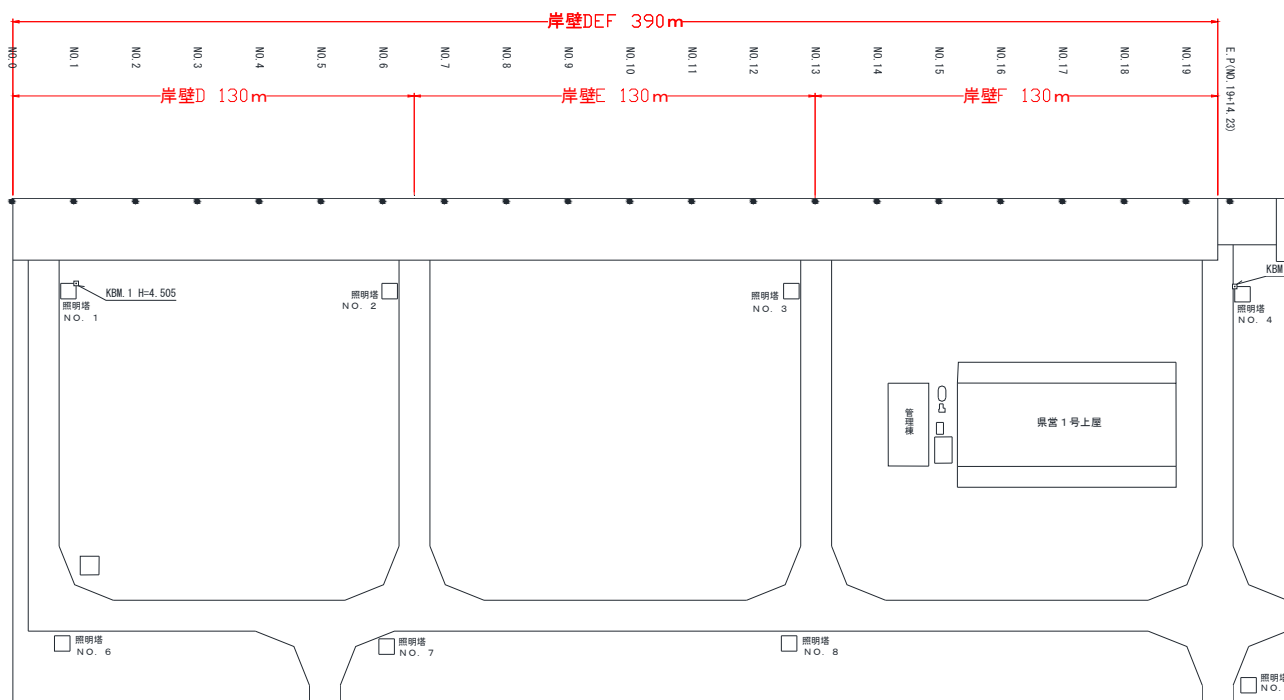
210 No.16 常陸那珂港区\_北埠頭地区 D・E・F 岸壁 (-7.5m) の平面図 (被災前)
